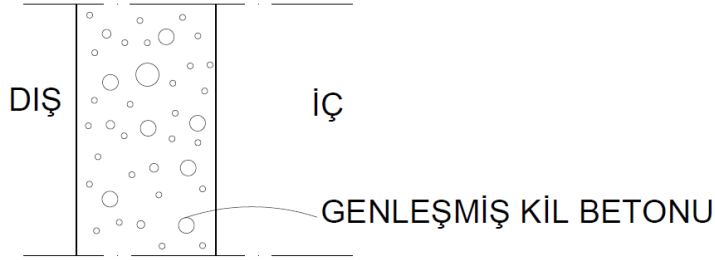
3 : Beton ve pişmiş toprak bloklı cephe panelleri
